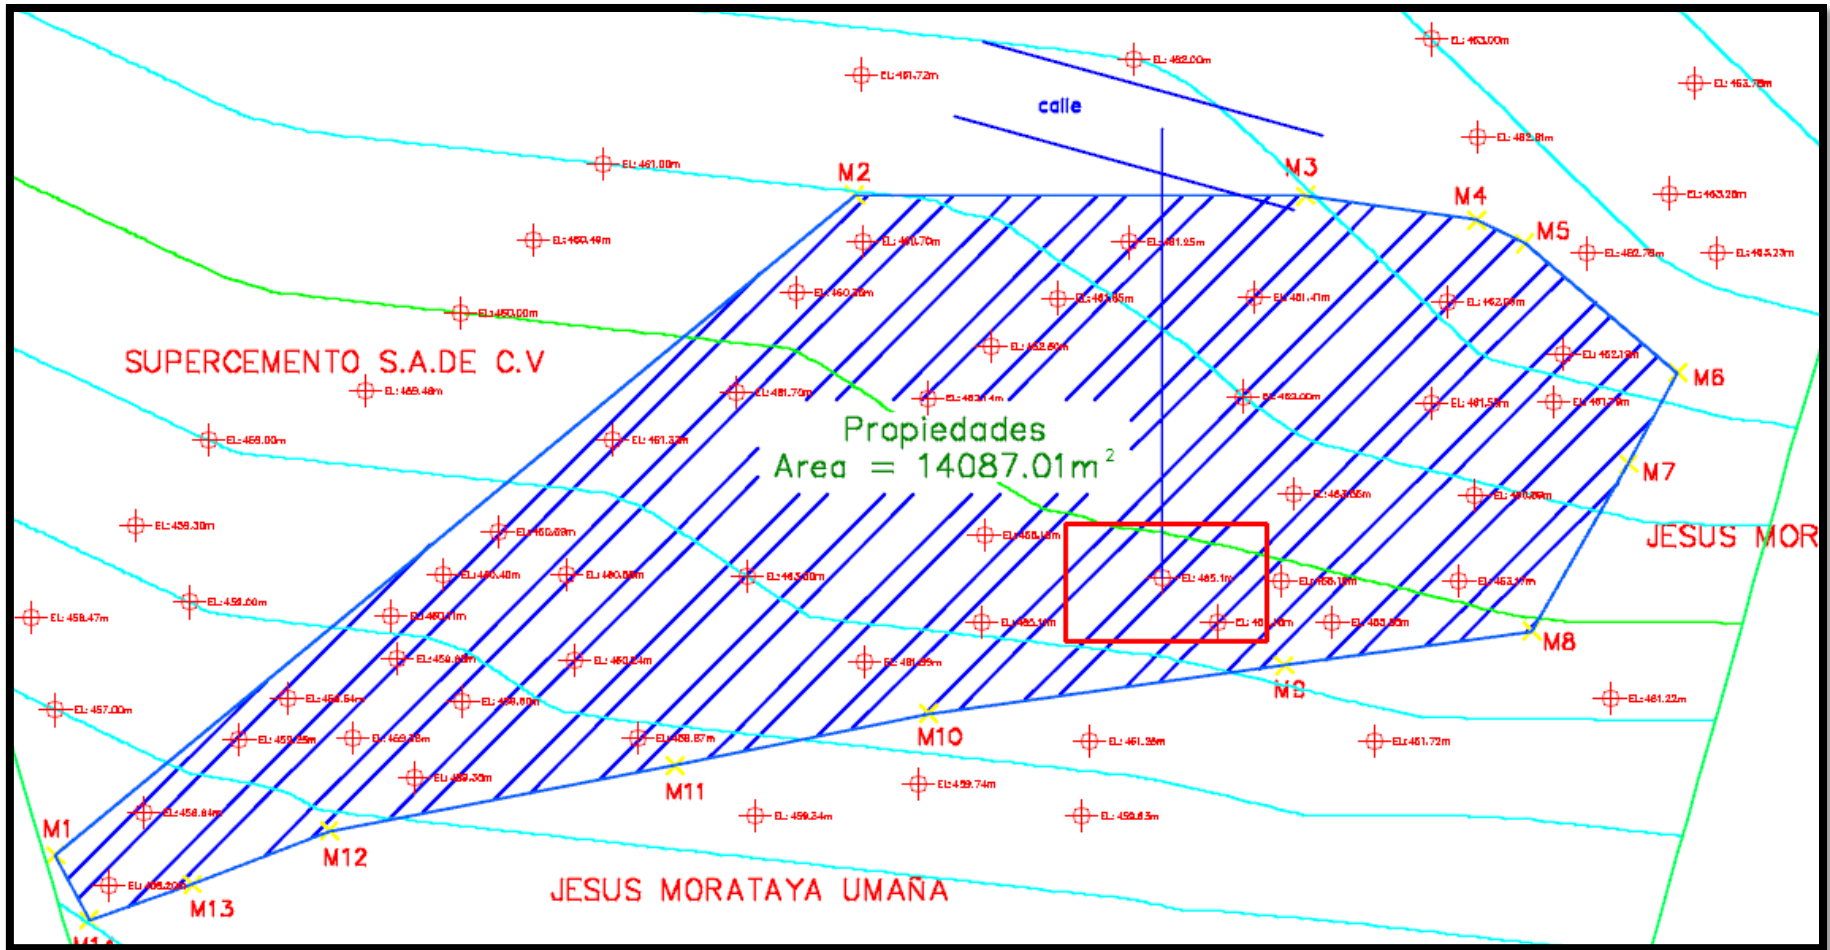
Plano topográfico con elevaciones y ubicación de la futura construcción, elaborado en auto CAD
